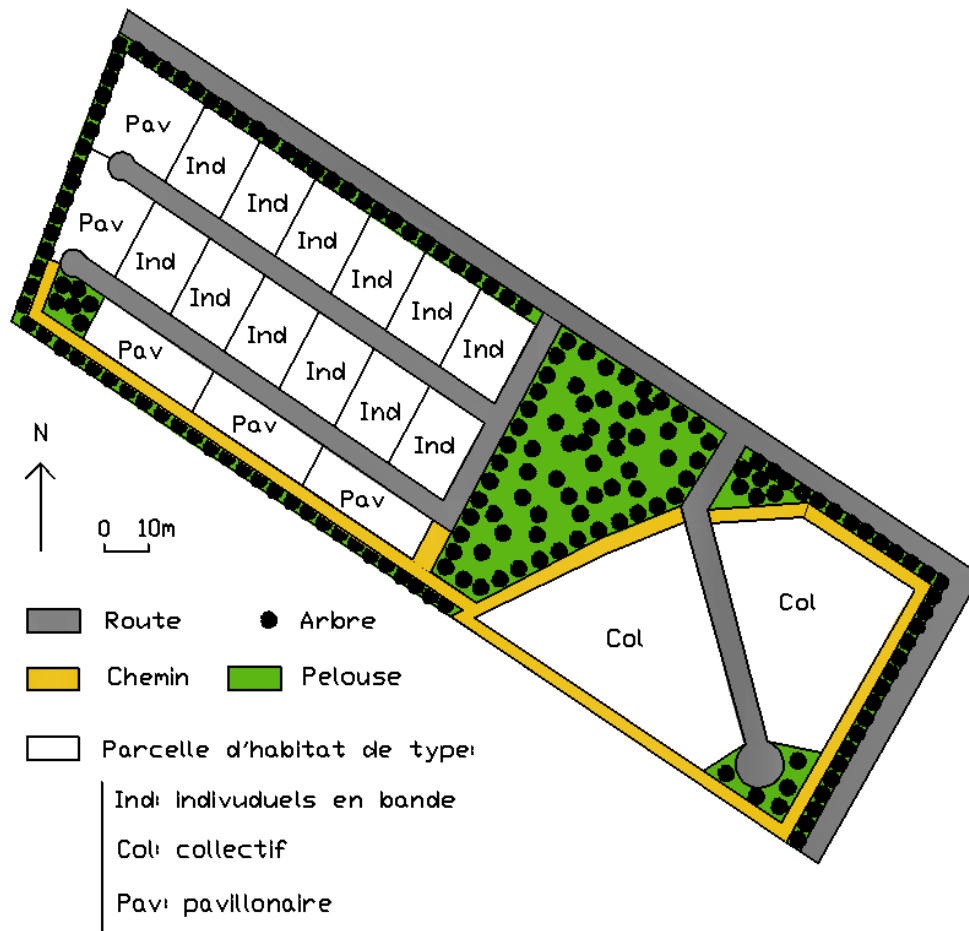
Proposition de plan masse pour la zone du Boulet Sud
